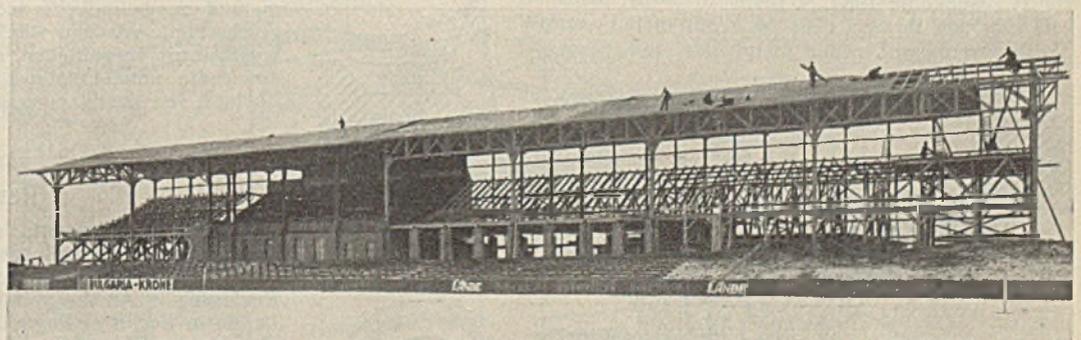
Tribüne V. f. B. Leipzig während der Ausführung.
